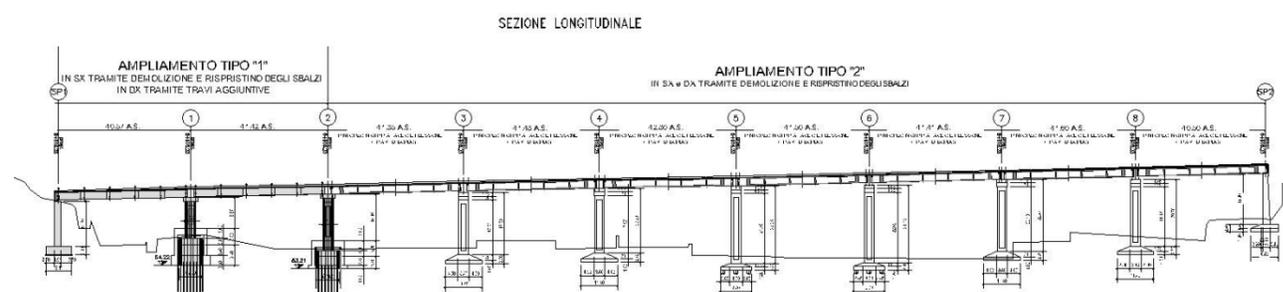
Sezione longitudinale viadotto Secca Nord
